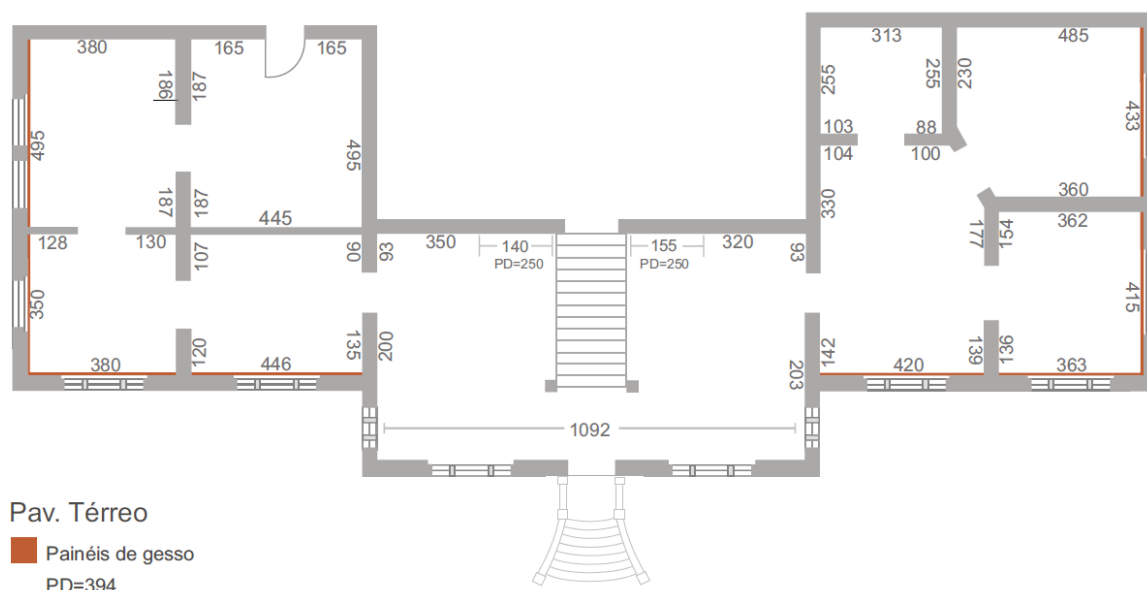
Planta baixa do pavimento térreo do prédio principal do MAC-PR
